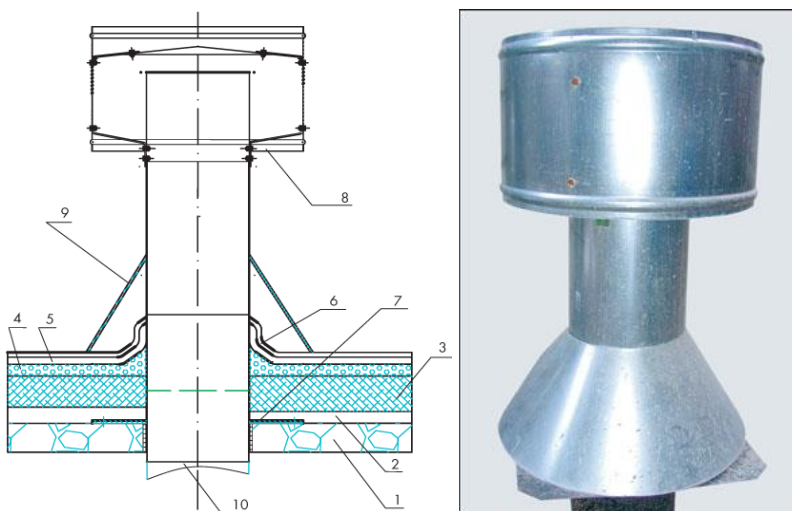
Схема вентиляційного вузла сміттепроводу:
